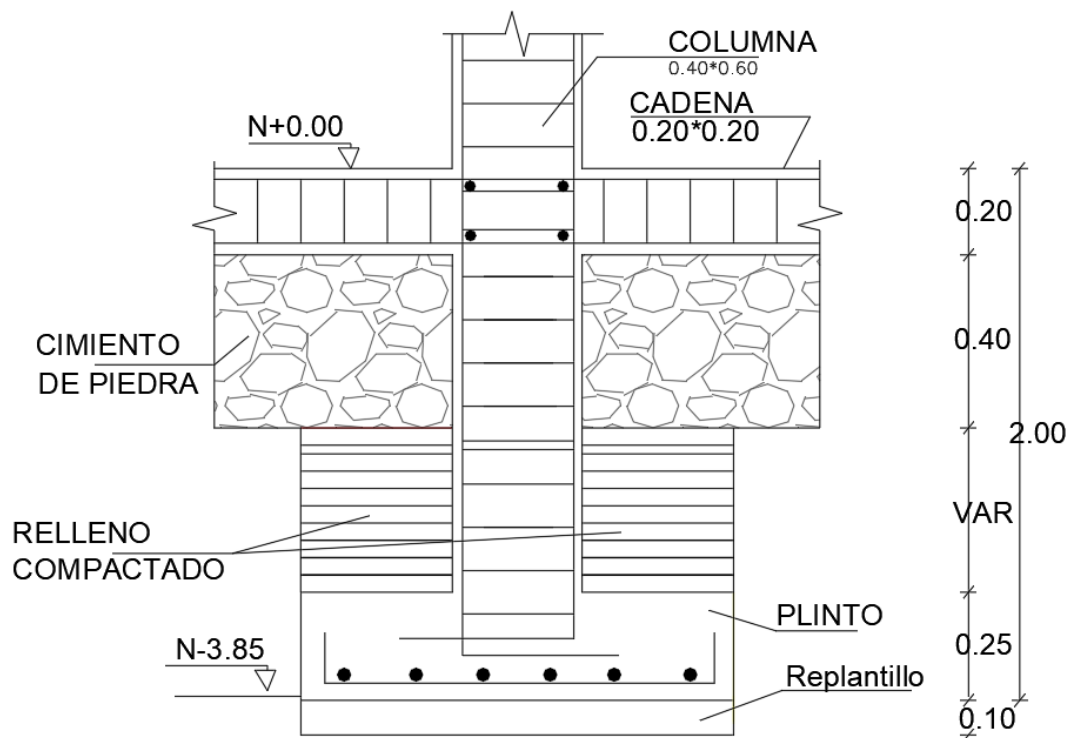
Detalle de cimentación. Vista en Corte. Diagrama del autor.
